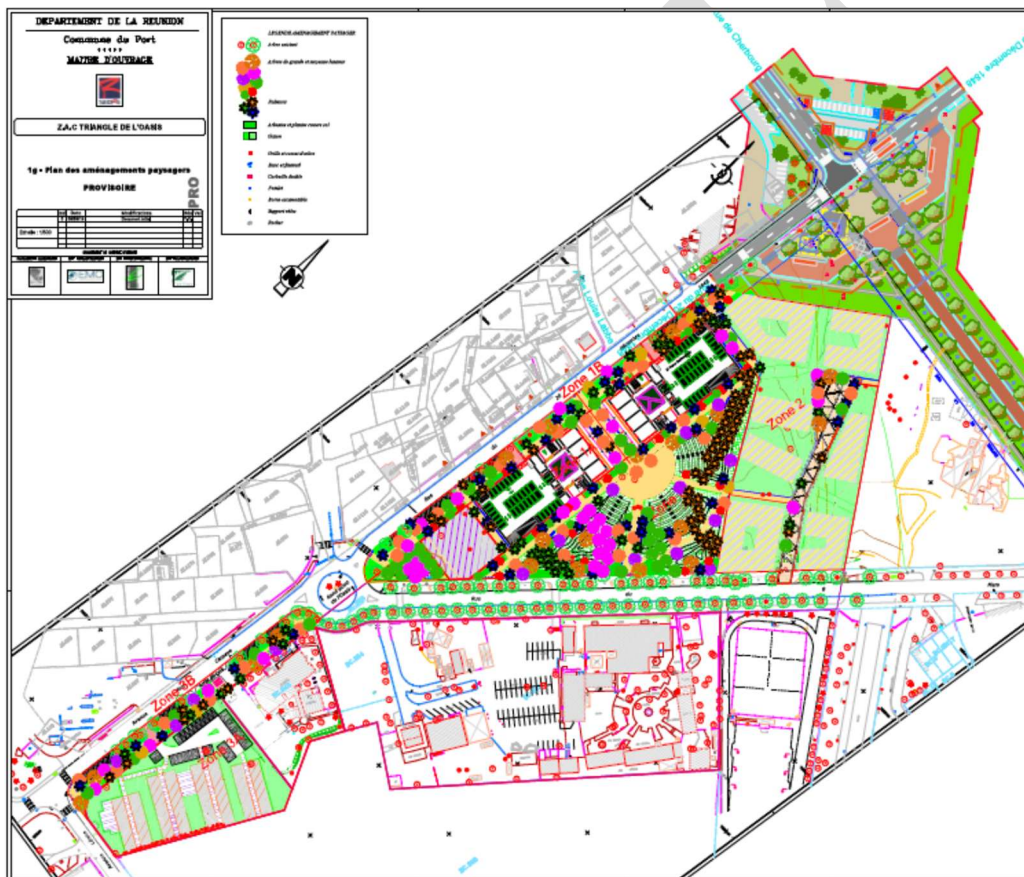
PLAN MASSE - ZONAGE DES TRAVAUX
